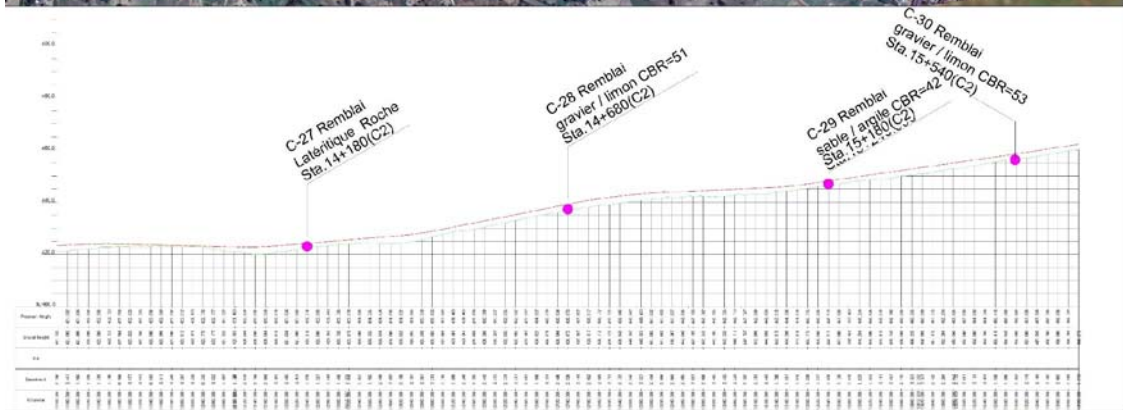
Coordination des travaux d'excavation (9), (10)
